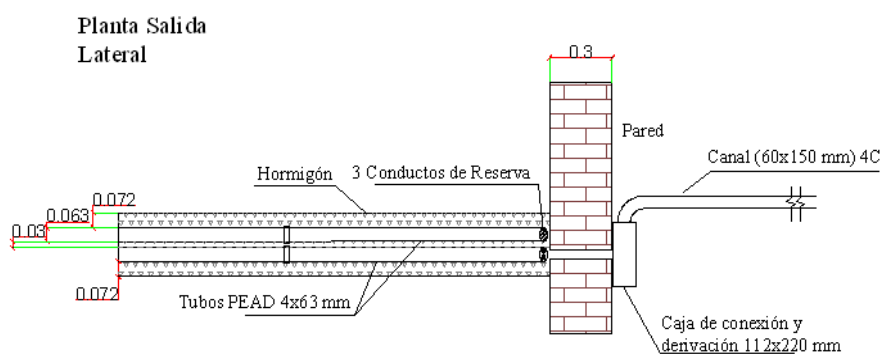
Planta salida lateral a fachada de la Red de Acceso
